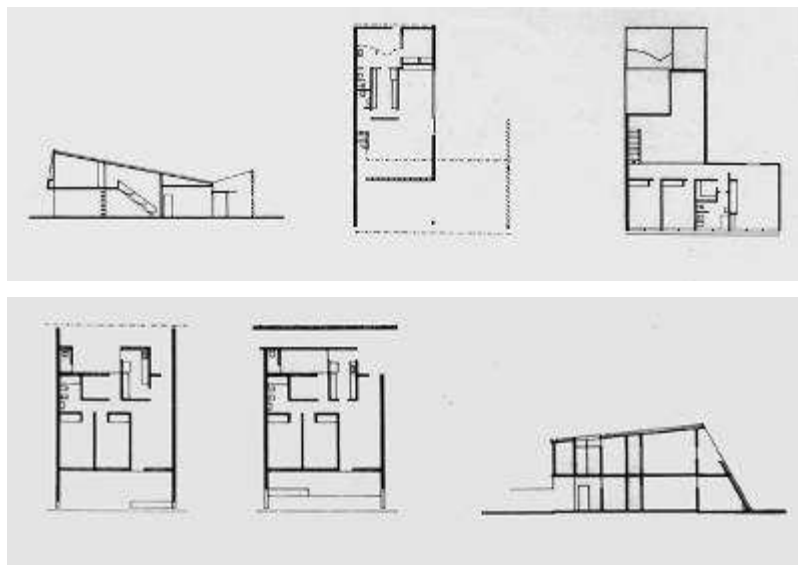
y 12 : Planta y Secciones de distintas tipologías de los módulos de vivienda . Fuente: BOTEY Josep Ma. Oscar Niemeyer: Obras y proyectos Works and Projects. Barcelona, España. Gustavo Gili. 2005.
